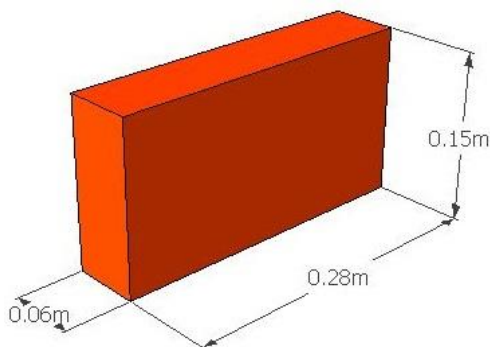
Dimensiones Tolete de Arcilla en posición de canto.
